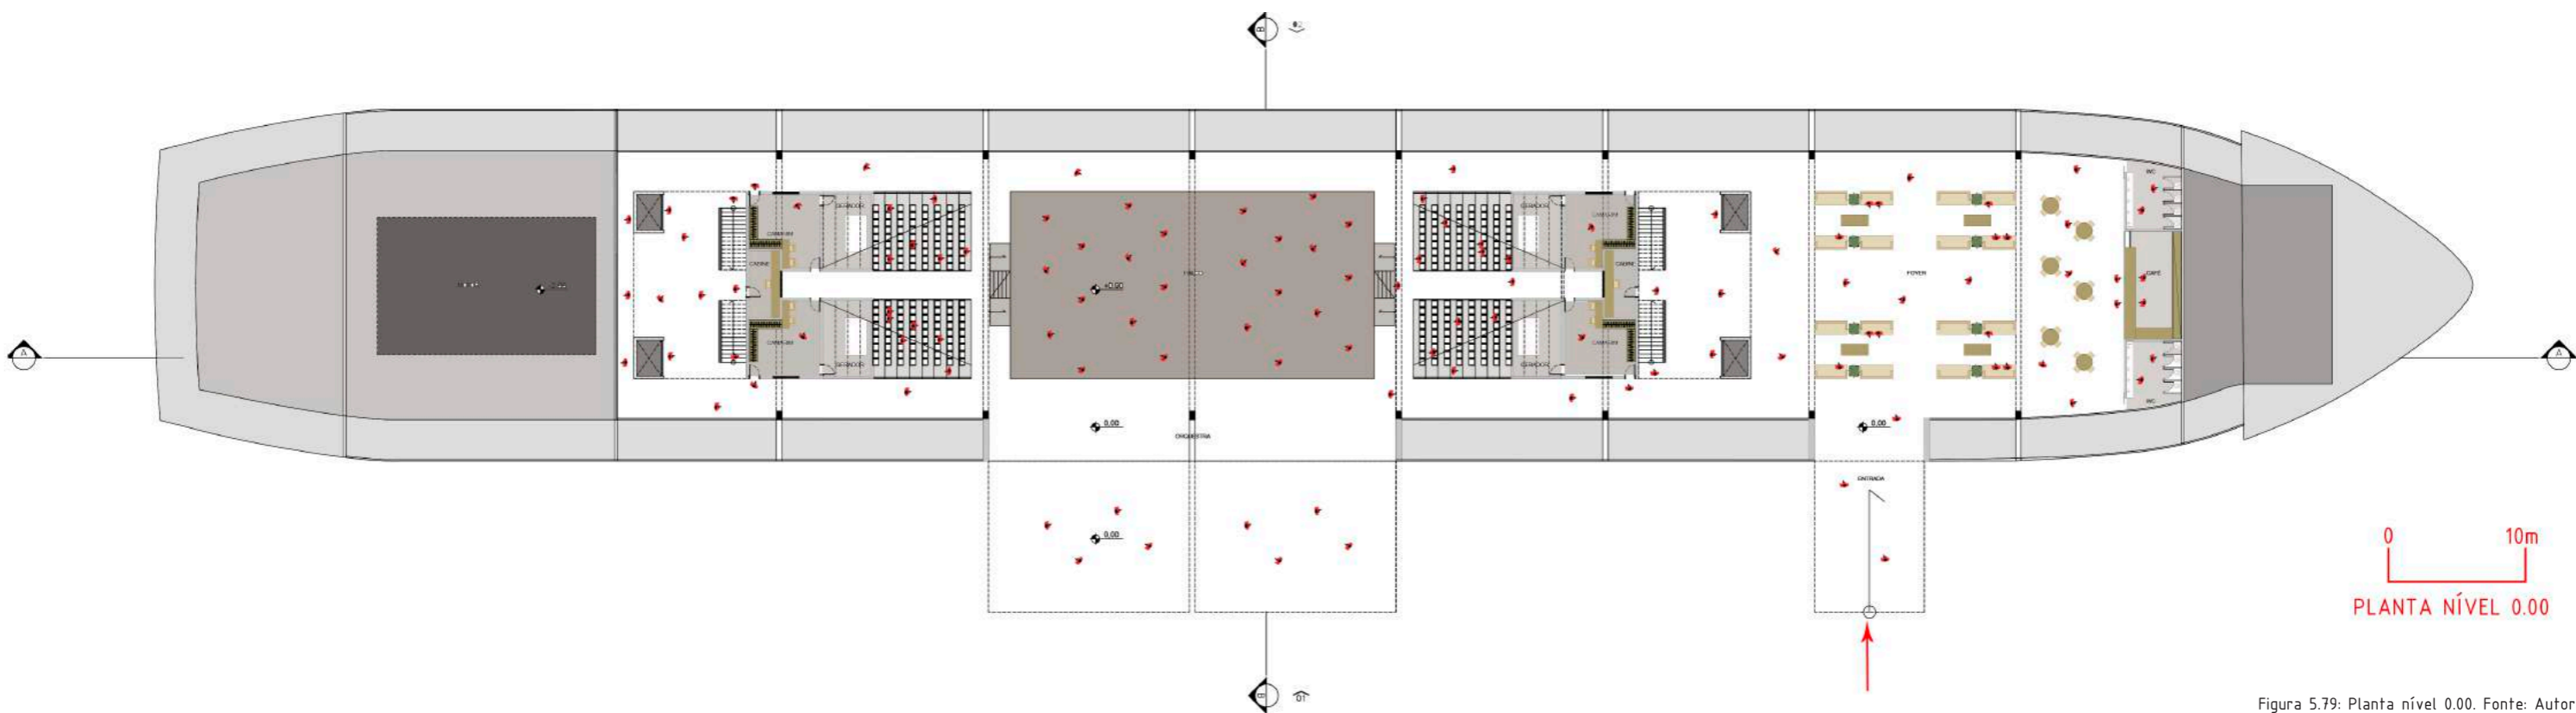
Planta nível 0.00. Fonte: Autora.
